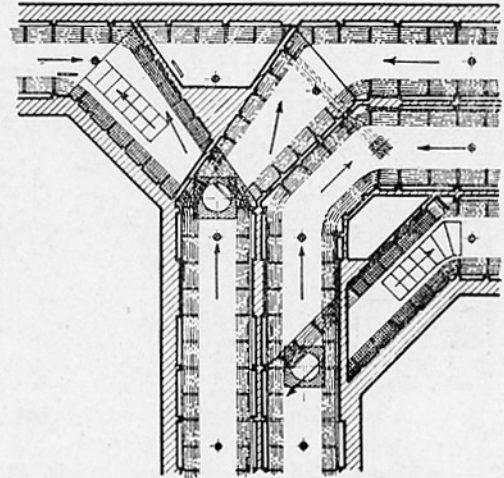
Plan de l'ouvrage de jonction des galeries de filerie.
